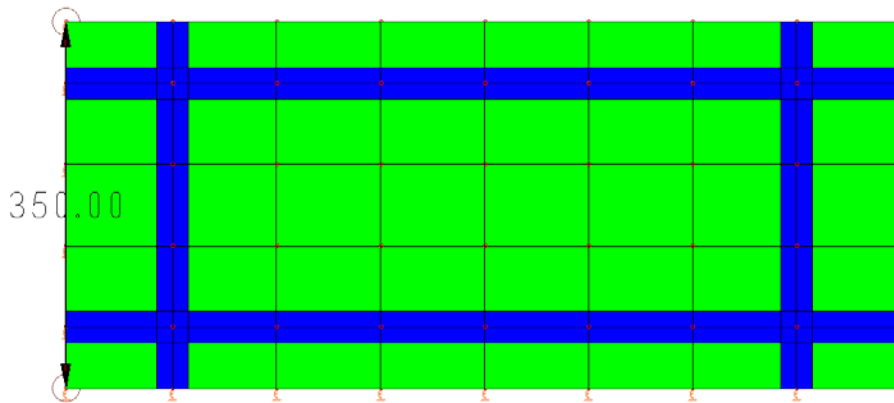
Vista in Pianta Platea e Travi di Fondazione
